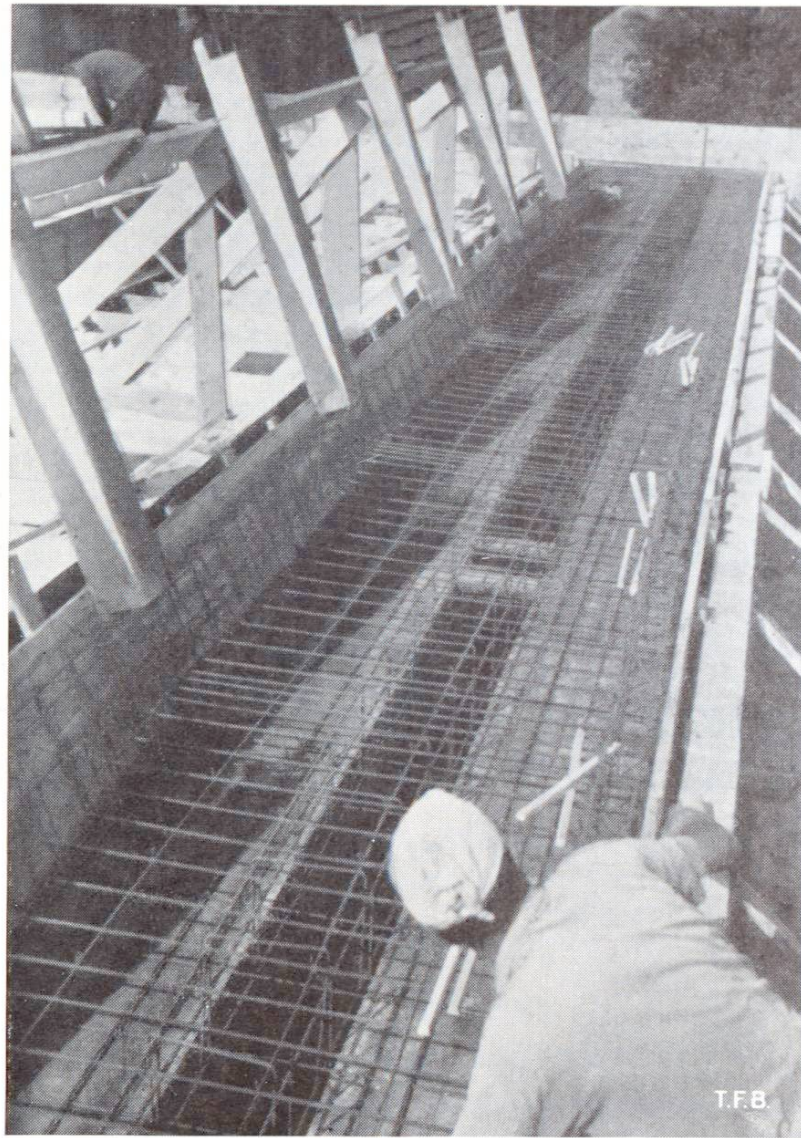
Armature d'une poutre en gouttière. Les poinçons sont maintenus en place par un échaffaudage
